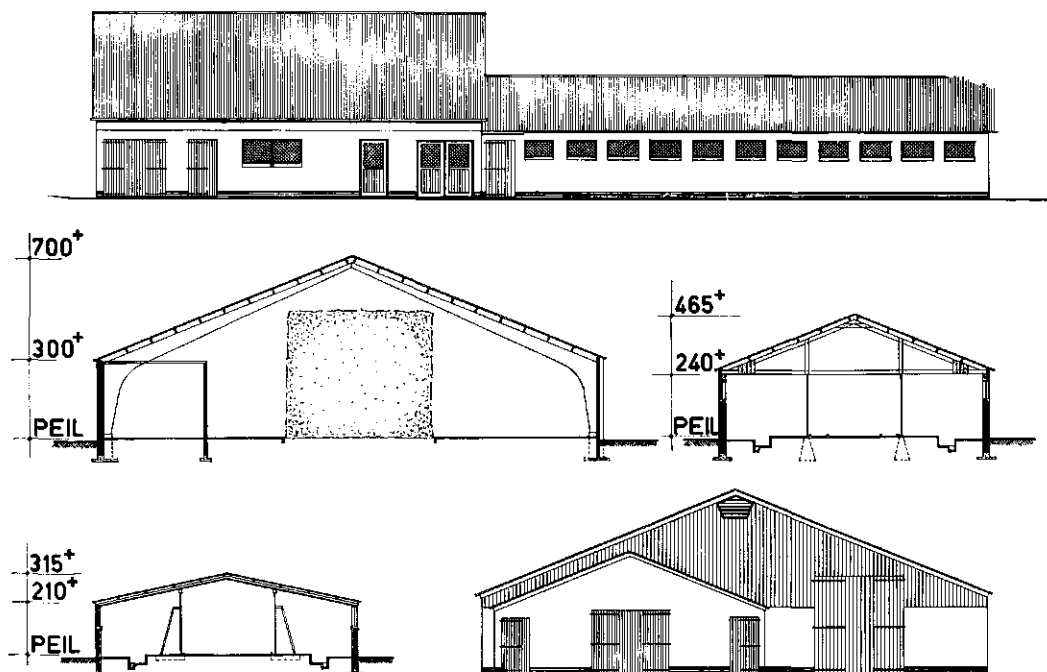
Plan A: gevels en doorsneden. Cross-section of farm A.
